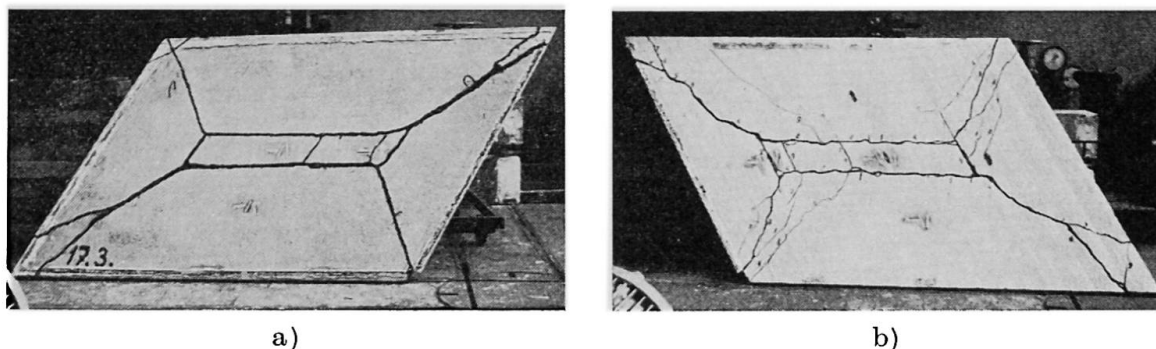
Fissures sur la face a) supérieure, b) inférieure d'une dalle oblique avec appui articulé le long du pourtour. Dalle n° 4.
